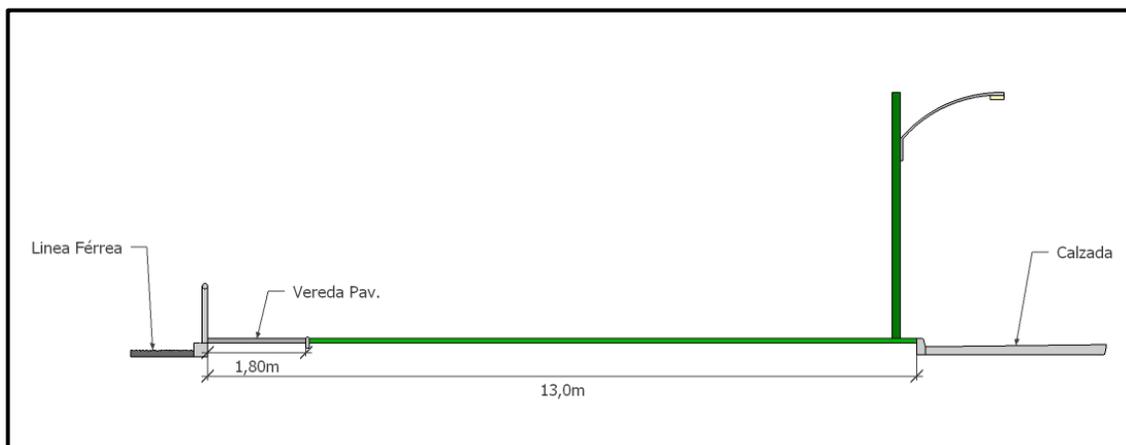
Perfil Transversal Eje A (Av. España) / Sector A2 / 4
